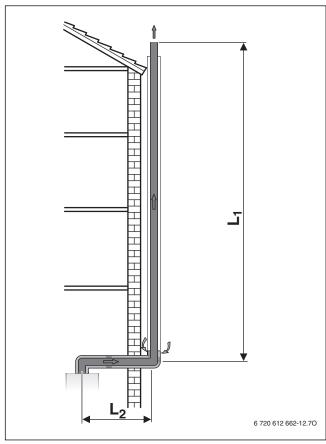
Abgasführung an der Fassade nach  $C_{53x}$
